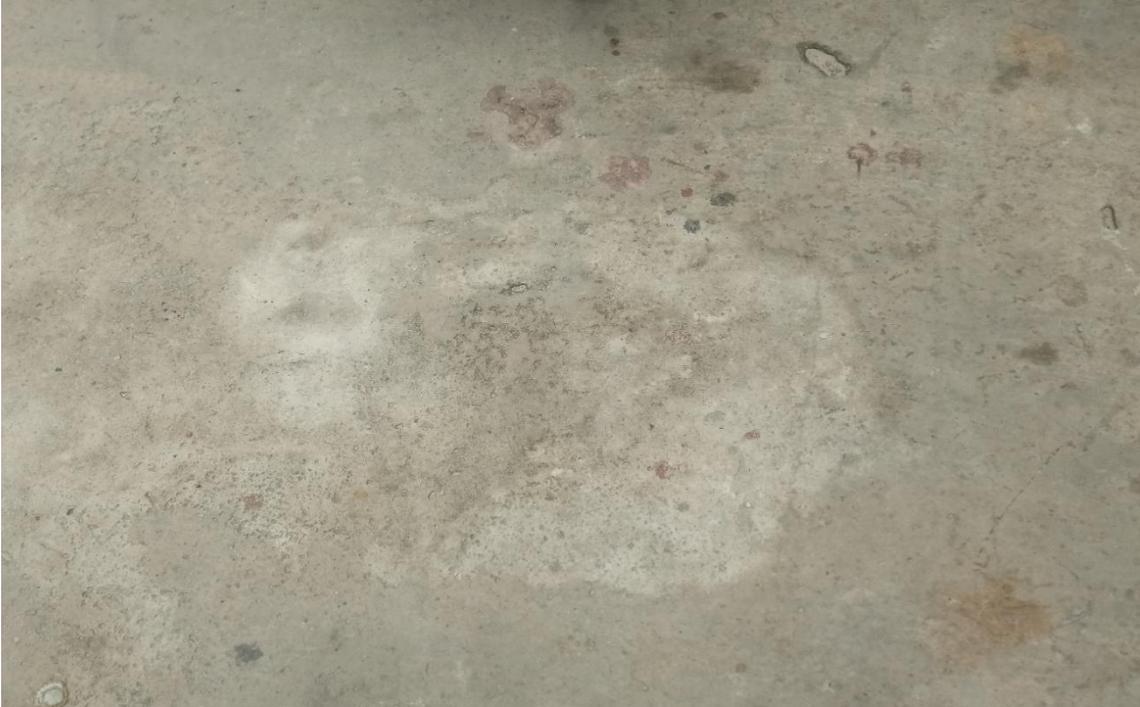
Grieta N° 13 con deterioro: Surgencia de finos
